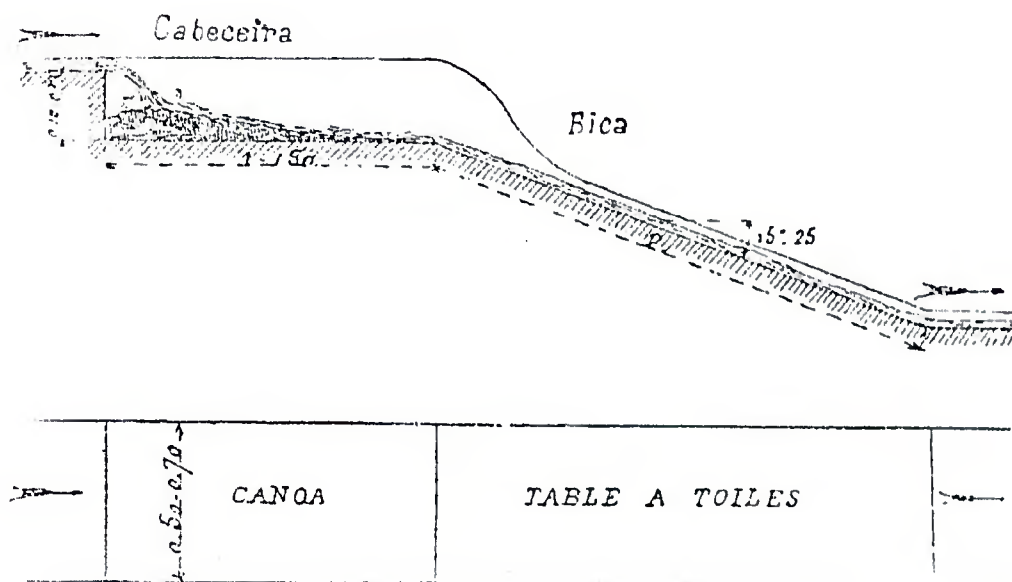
Corte e plano de uma canoa (FERRAND, 1998: 118)
